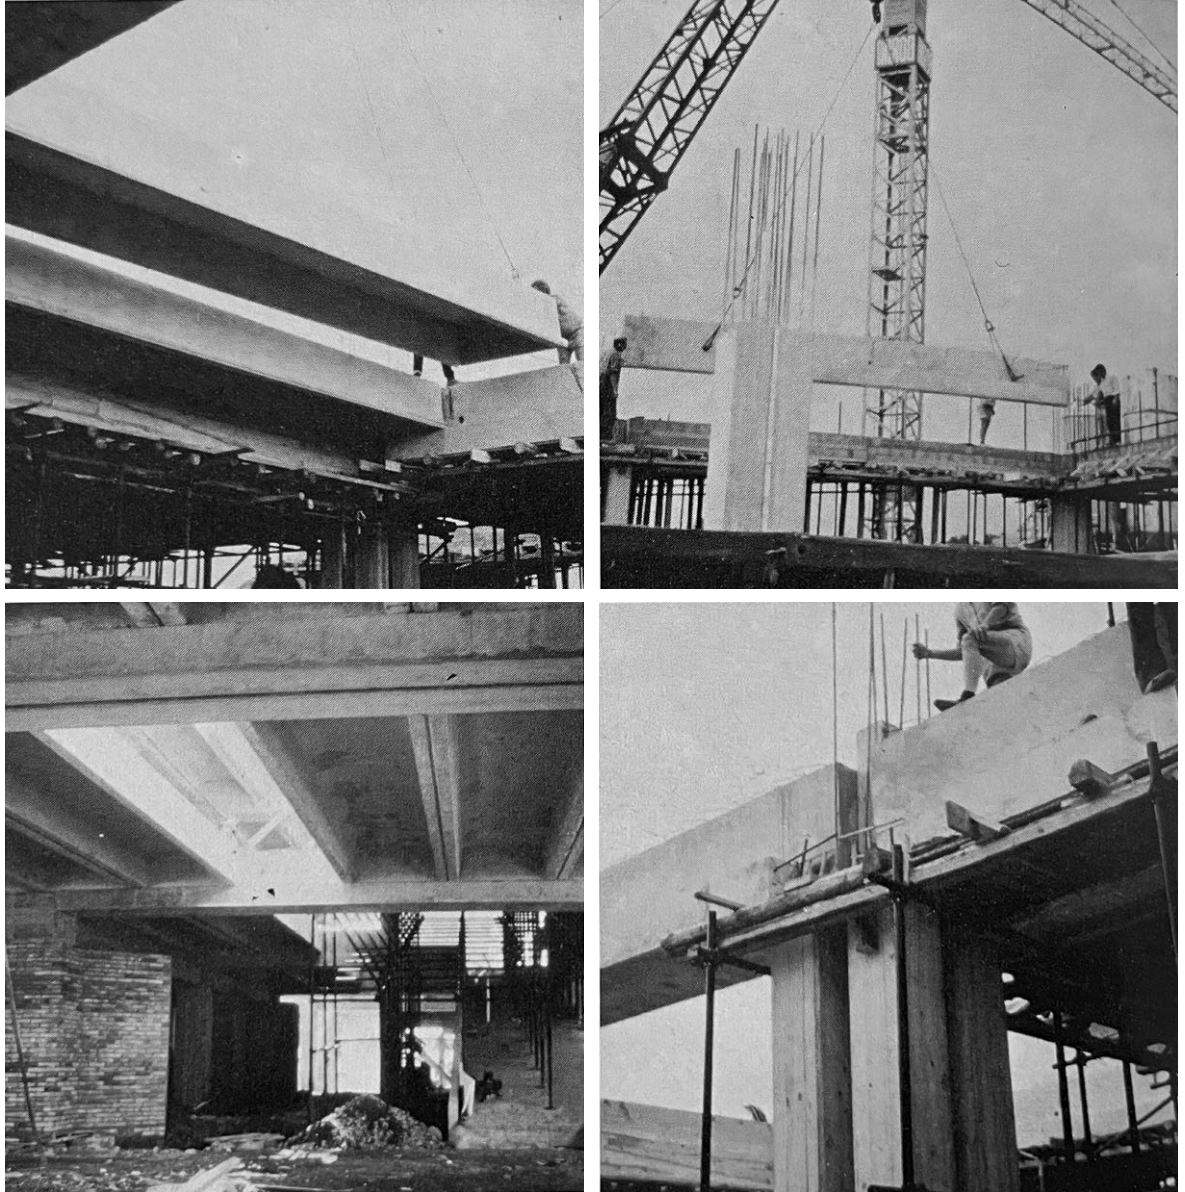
Gli elementi della struttura: i pilastri, le travi e i tegoli prefabbricati a sezione nervata.
